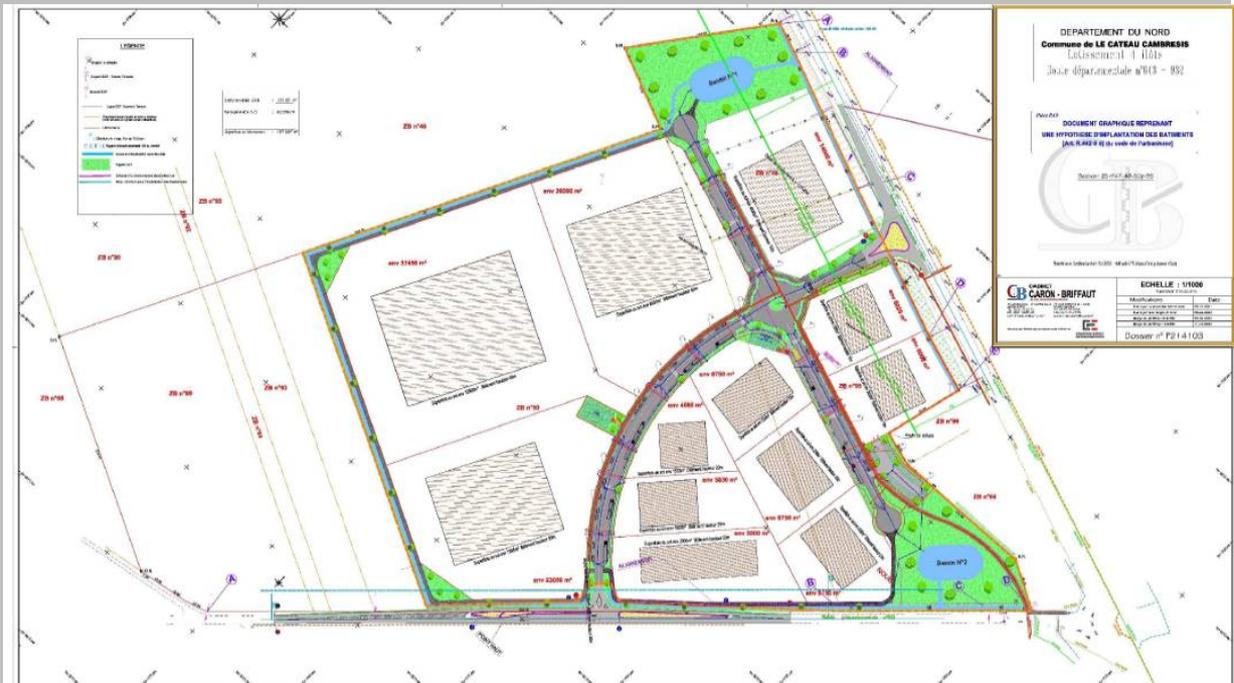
Hypothèses d'implantation des bâtiments sur la zone - plan masse
